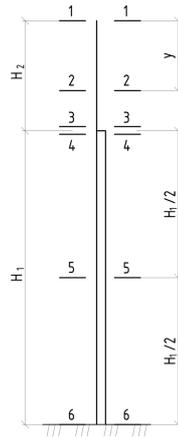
Схема расположения расчетных сечений по высоте колонны
